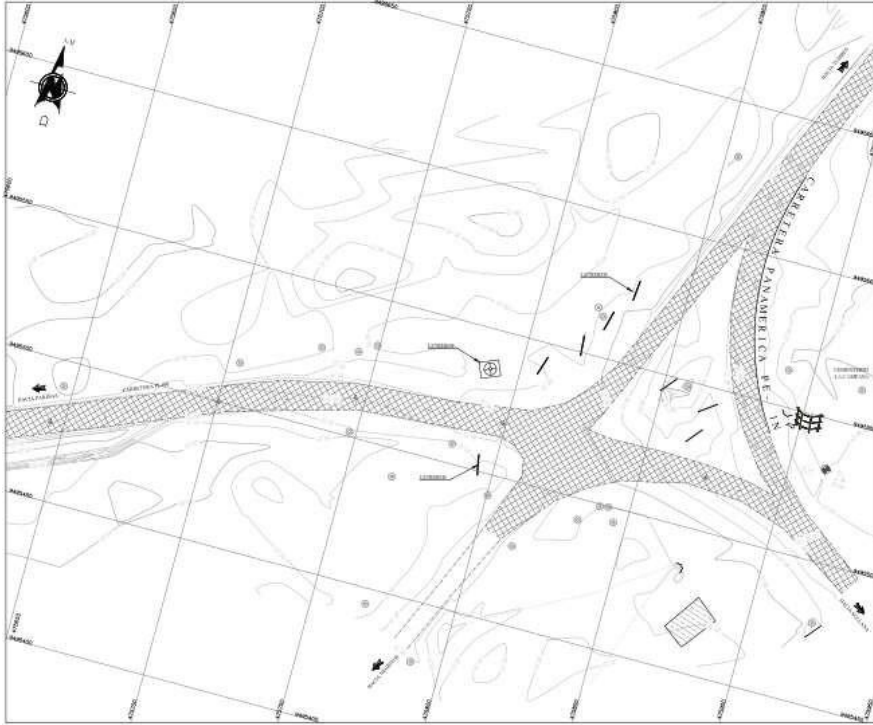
Plano de planta topográfica de la intersección “La Campana”, Talara, Piura.
